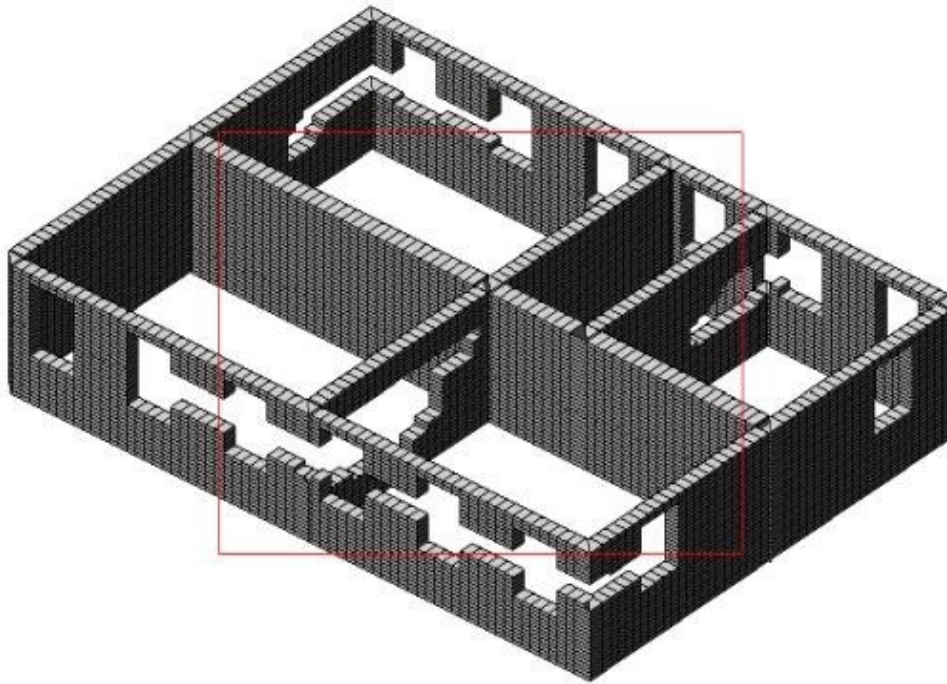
Схема поверху із зруйнованими цегляними стінами
